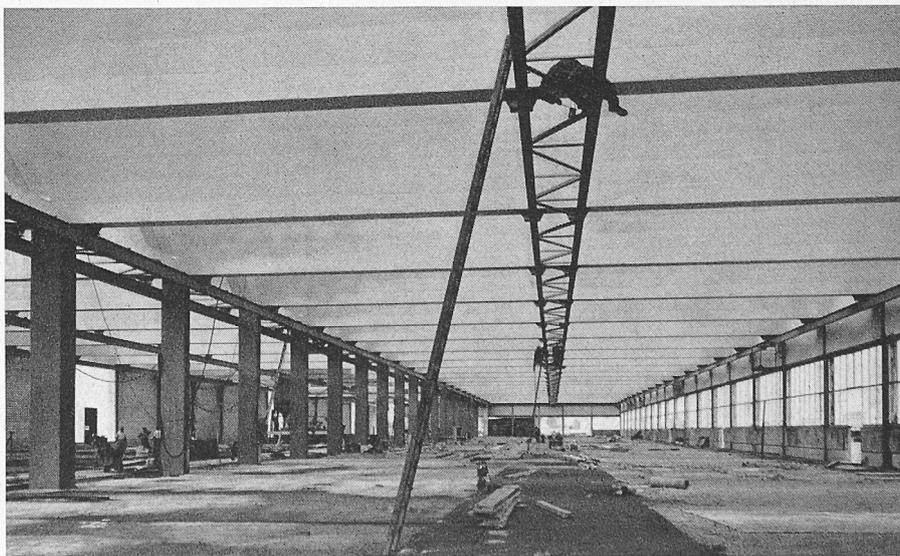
Blick aus der Weichenbauhalle nach dem Südhang des Juras
